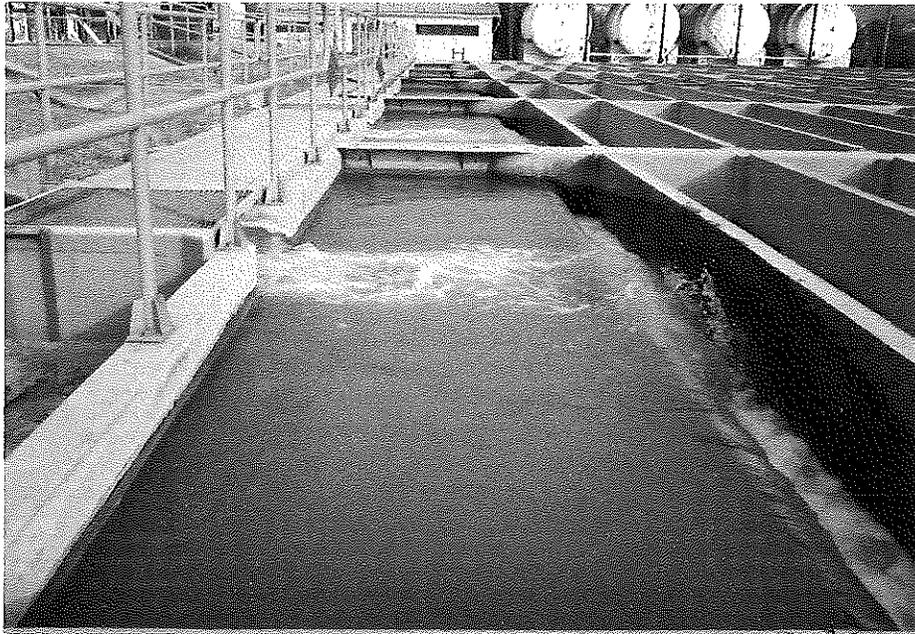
Zona de transición de los canales Parshall hacia los floculadores verticales
